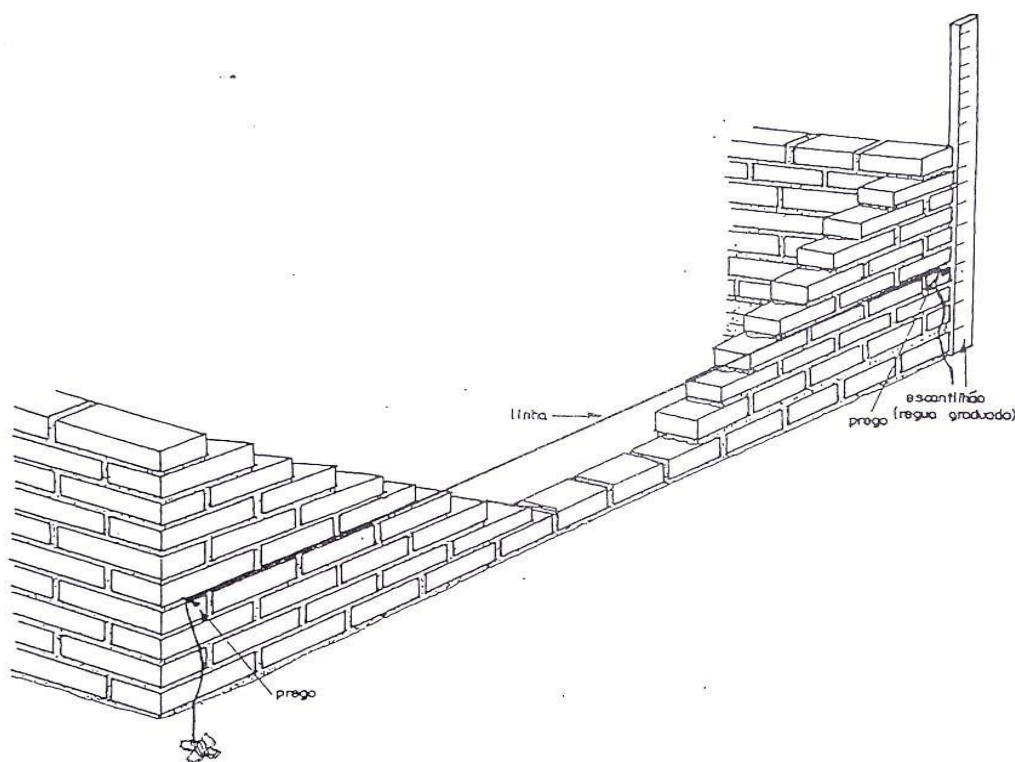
Detalhe do nivelamento da elevação da alvenaria.
